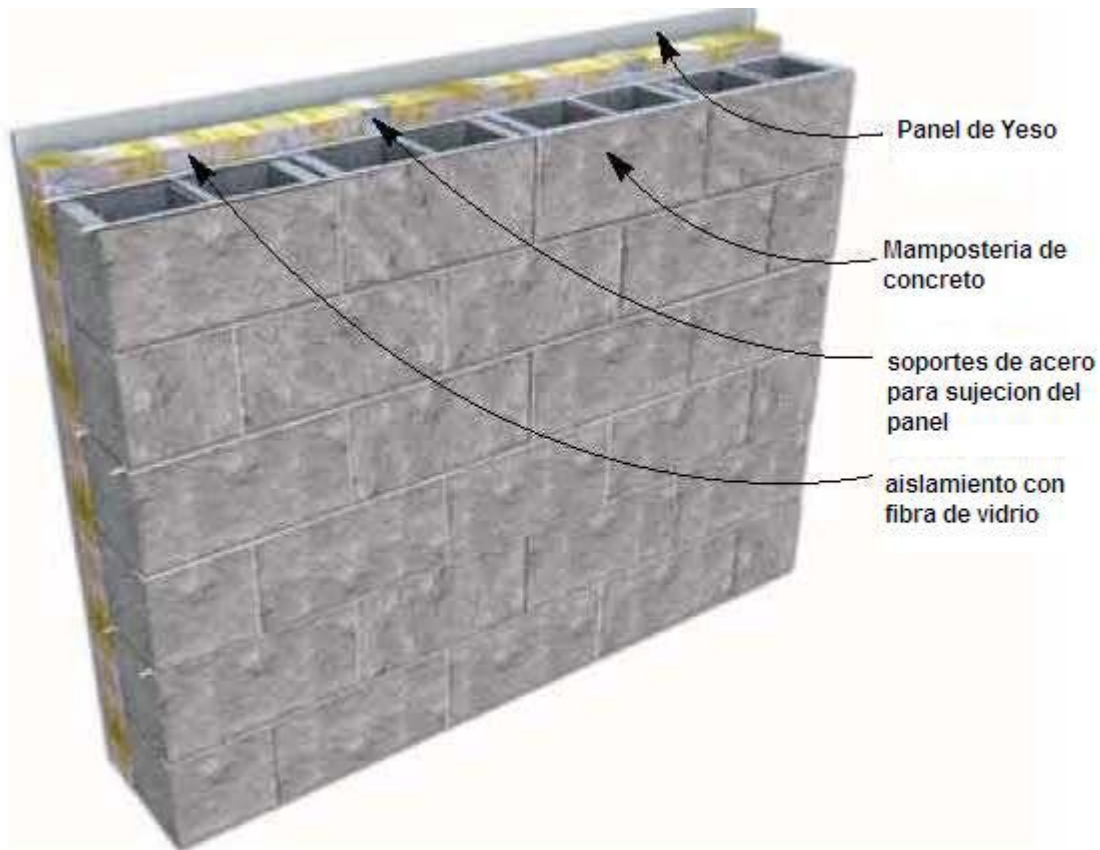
, aislamiento de muro de mampostería con uso de paneles de yeso, y tejido de fibra de vidrio, tomado de NCMA, thermal catalog of concrete masonry assamblies
